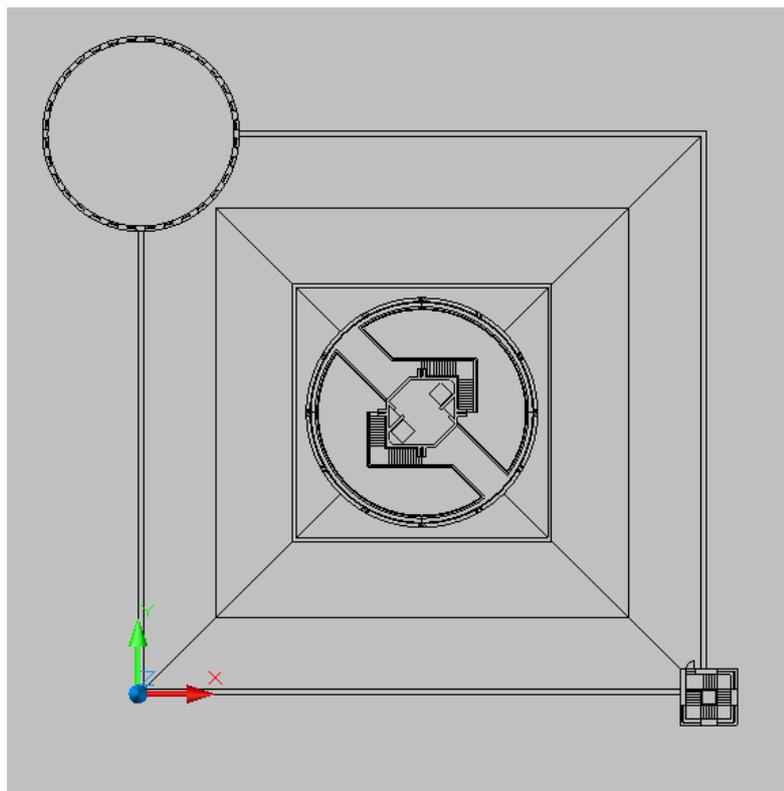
Plano de la segunda planta de la escuela en 2D
